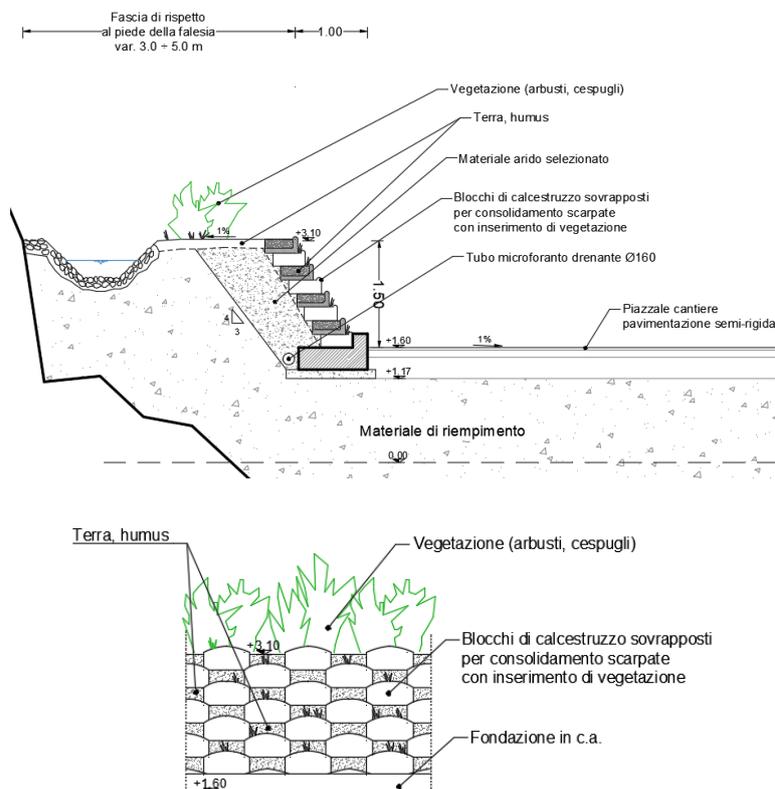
Sezione e vista frontale della protezione della scarpata del rilevato.
